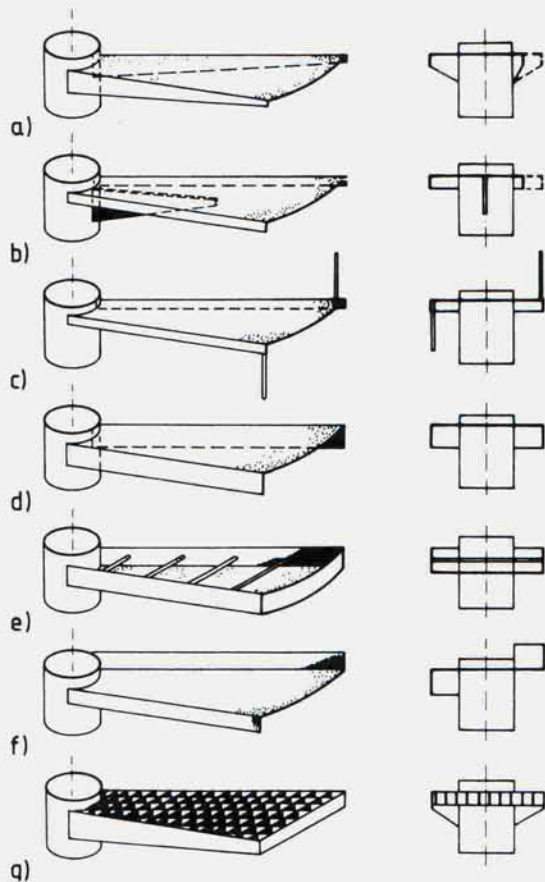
Устройство стальных ступеней винтовой лестницы и их вид в разрезе
